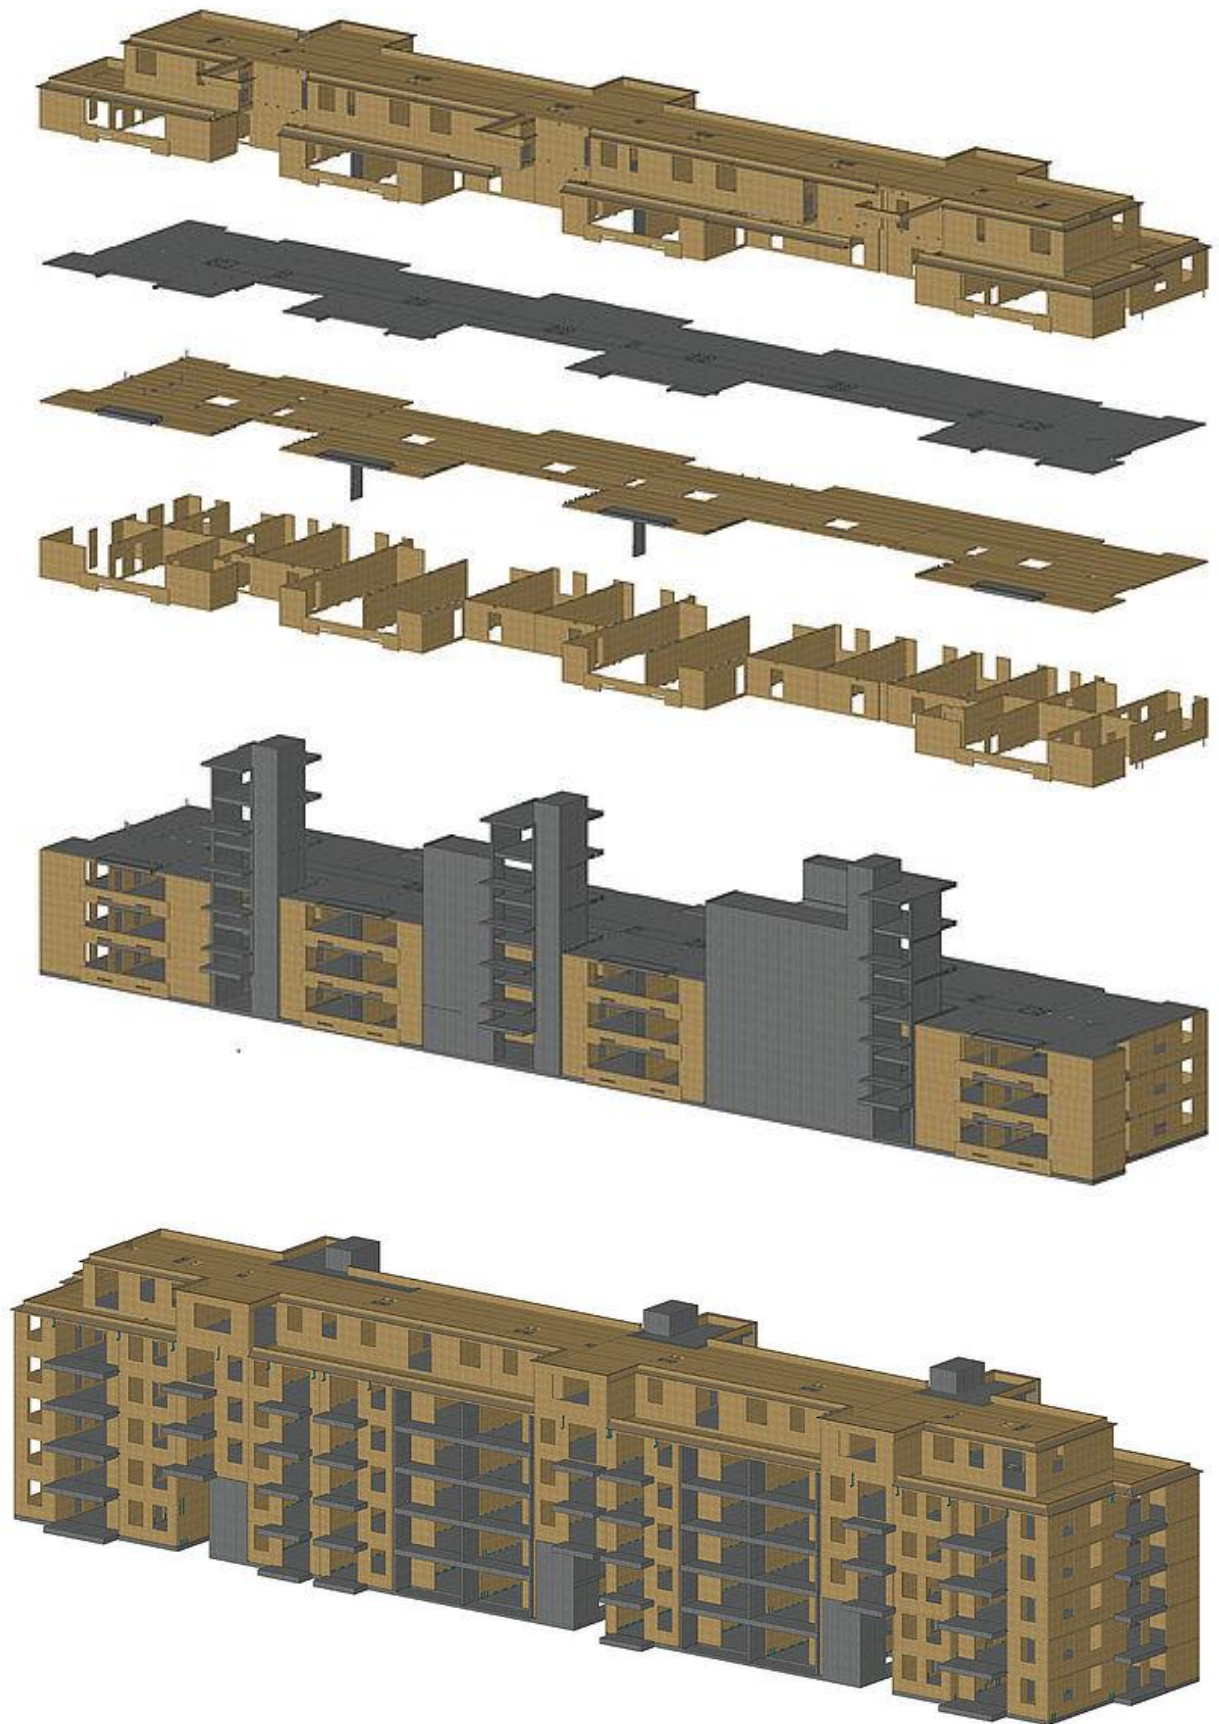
Konstruktion und Tragwerk im Holz-Beton Verbundbau vom Wohnbau Wagramer Straße [75]
